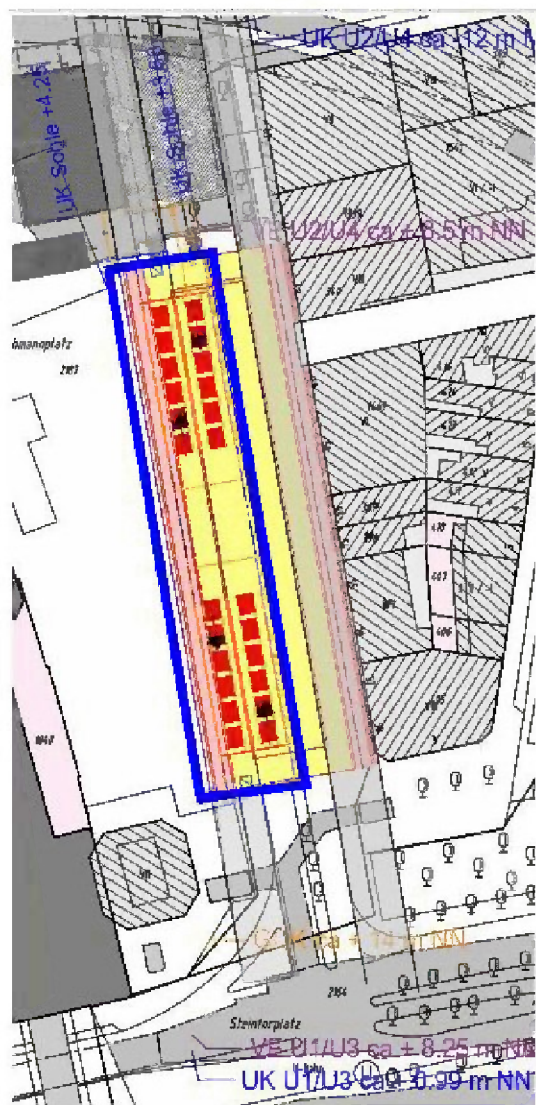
Lageplan Haltestelle Hauptbahnhof Kirchenallee
